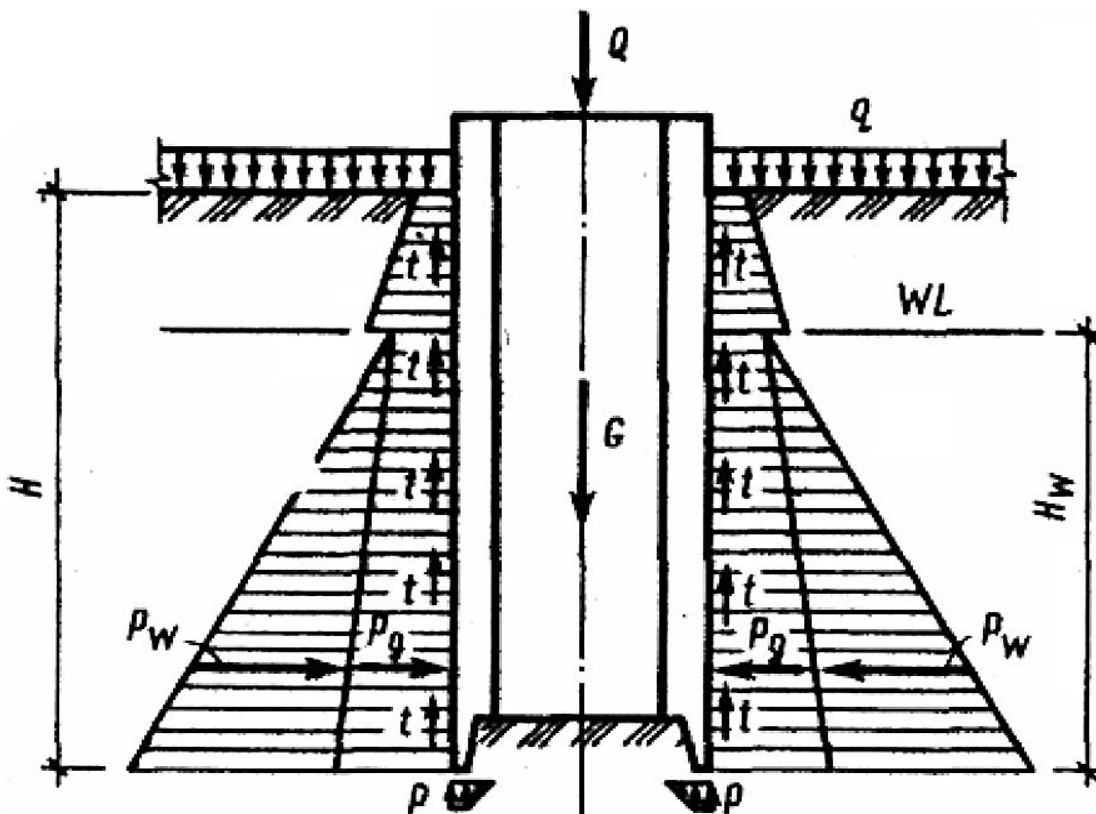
Схема навантажень, що діють на опускний колодезь під час його занурення
